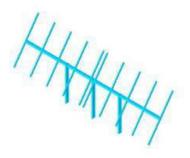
Vista assonometrica modello strutturale con posizione della "vela" inclinata di 60°
